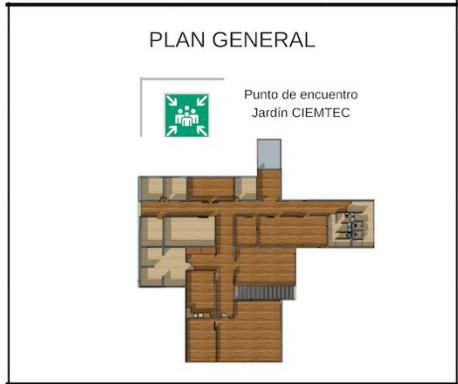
Croquis de evacuación Planta Baja CIEMTEC I1
